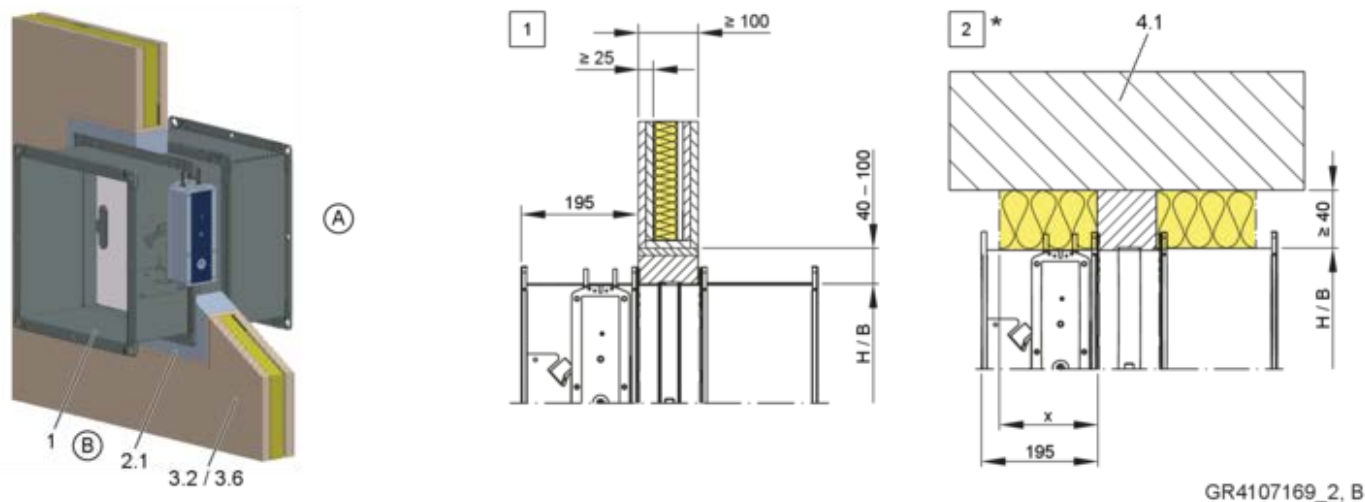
montagem em argamassa numa parede divisória leve, parede corta-fogo ou parede divisória de segurança
